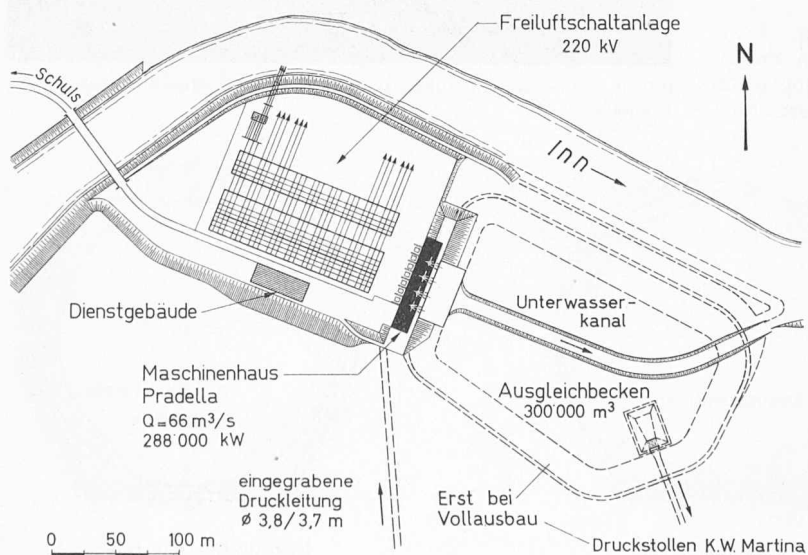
Lageplan der Zentrale Pradella, 1:6000
